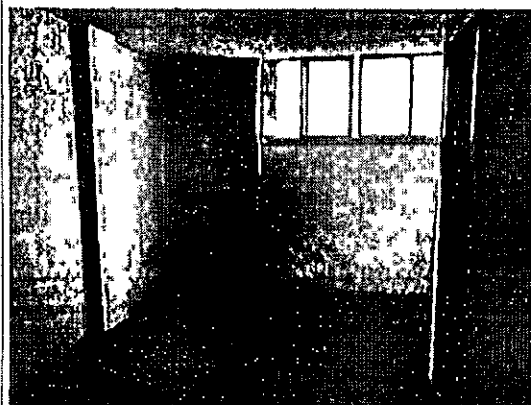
21º PAVTO | Sala com sinais de infiltração
